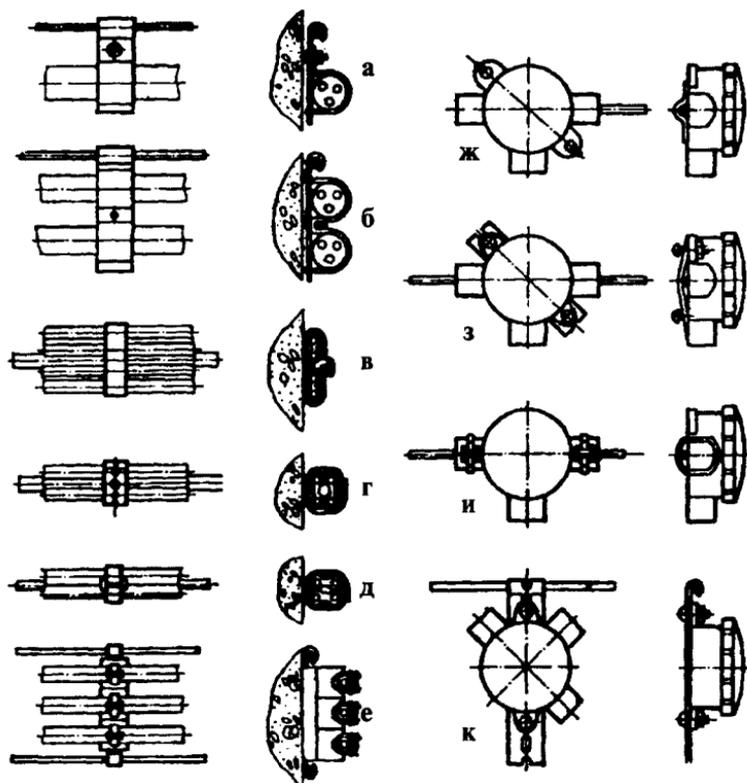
Прокладка кабеля и проводов по стенам с креплением к струнам:
